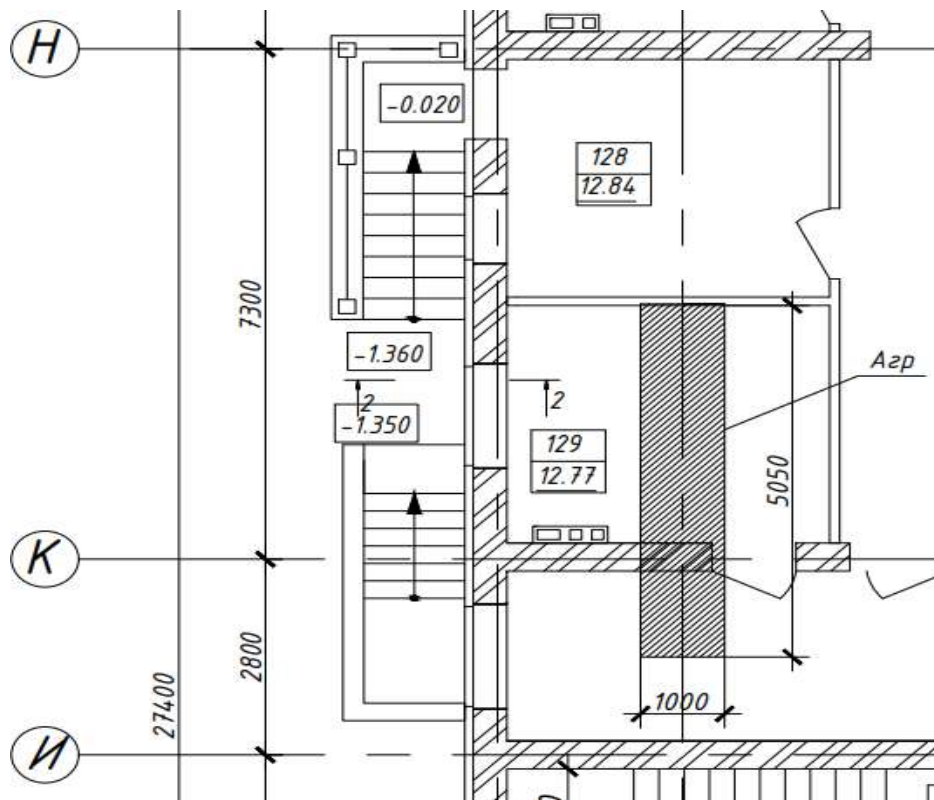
Фрагмент плана с грузовой площадью для фундаментов, расположенных в осях 2К (b=1.6м)
